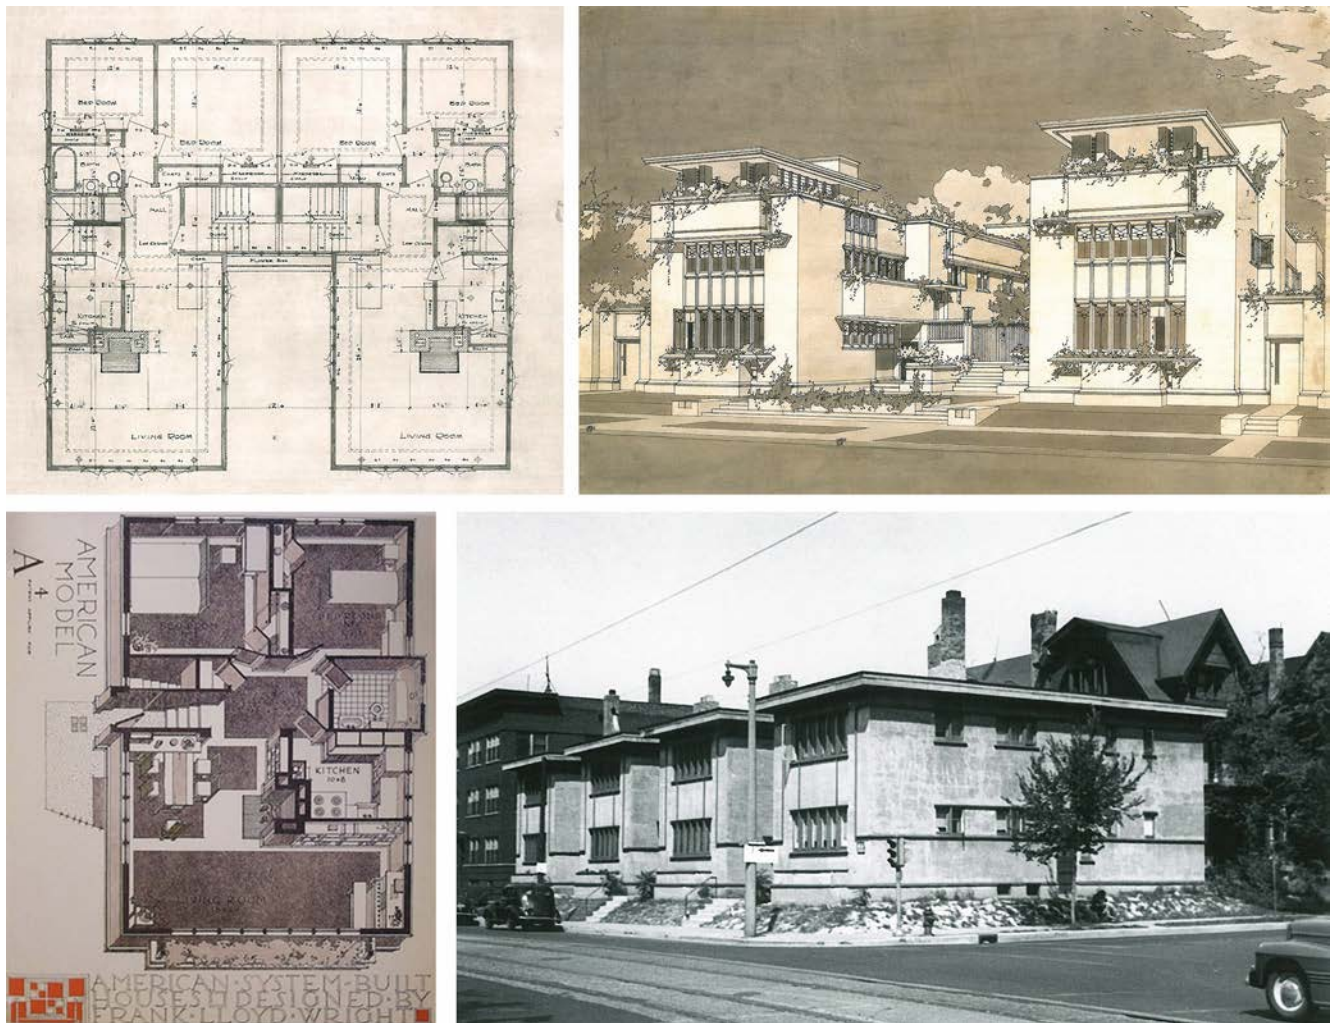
American System-Built Houses. Modelo A4 (ficha del catálogo) y Munkwitz Apartments (planta, perspectiva y vista desde la calle) (The Frank Lloyd Wright Foundation).
